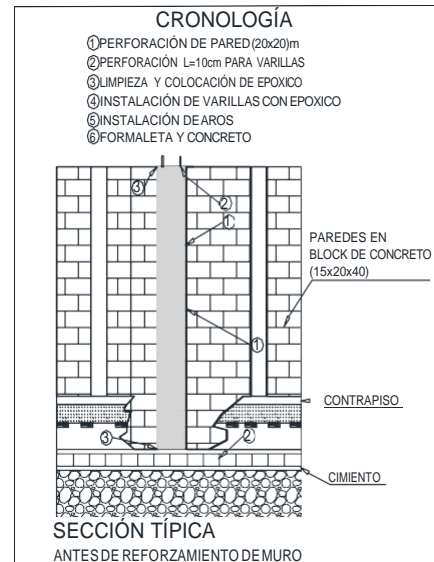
DEMOLICIÓN PARA REFORZAMIENTO DE MURO.
